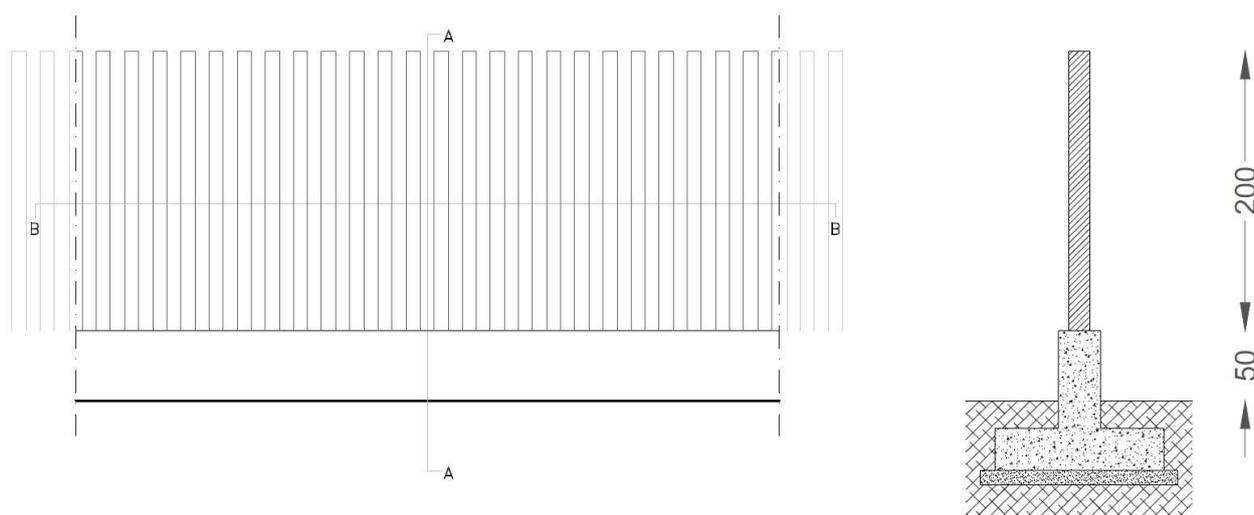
Particolare recinzione Stazione utente di trasformazione
